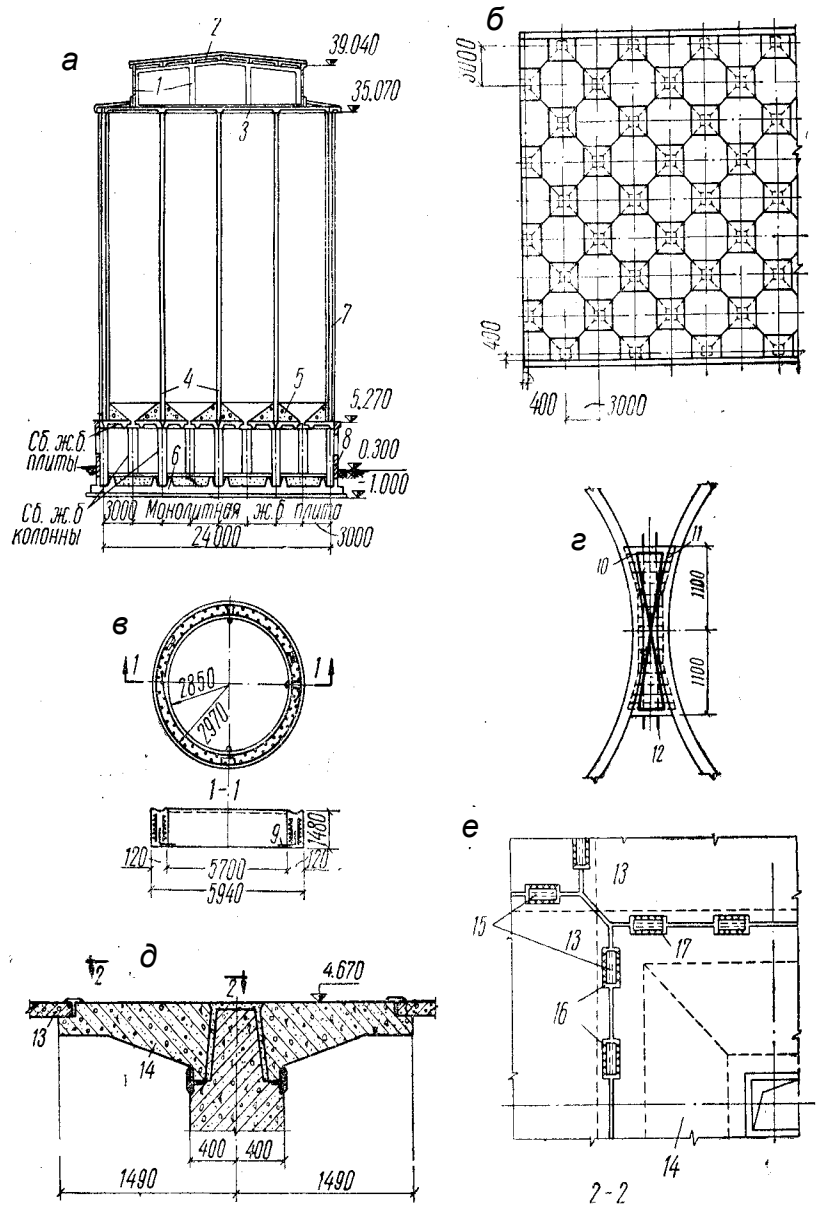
Силосный корпус, собираемый из железобетонных колец: а- поперечный разрез; б- монтажный план подсилосного перекрытия; в- сборное кольцо силосной банки; г- колонна; д, е- детали крепления элементов железобетонного перекрытия к колоннам; 1- сборная железобетонная рама; 2- крупнопанельные плиты; 3- сборная железобетонная плита; 4- сборные железобетонные кольца; 5- шлакобетон; 6- монолитная железобетонная плита; 7- пилястры в крайних банках; 8- бетонные блоки; 9- петли для монтажных подмостей; 10- арматурный каркас; 11- арматурная сетка; 12- выступ для крепления опалубки; 13- подсилосная плита; 14- капитель; 15-металлическая накладка; 16- закладные детали плиты; 17- закладные детали капители
